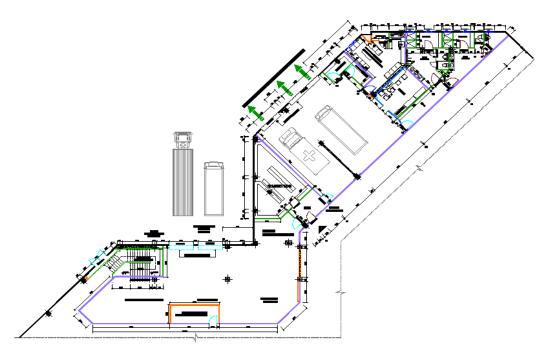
Plano Arquitectónico de Planta Baja del Centro Integral de Seguridad (CIS).
